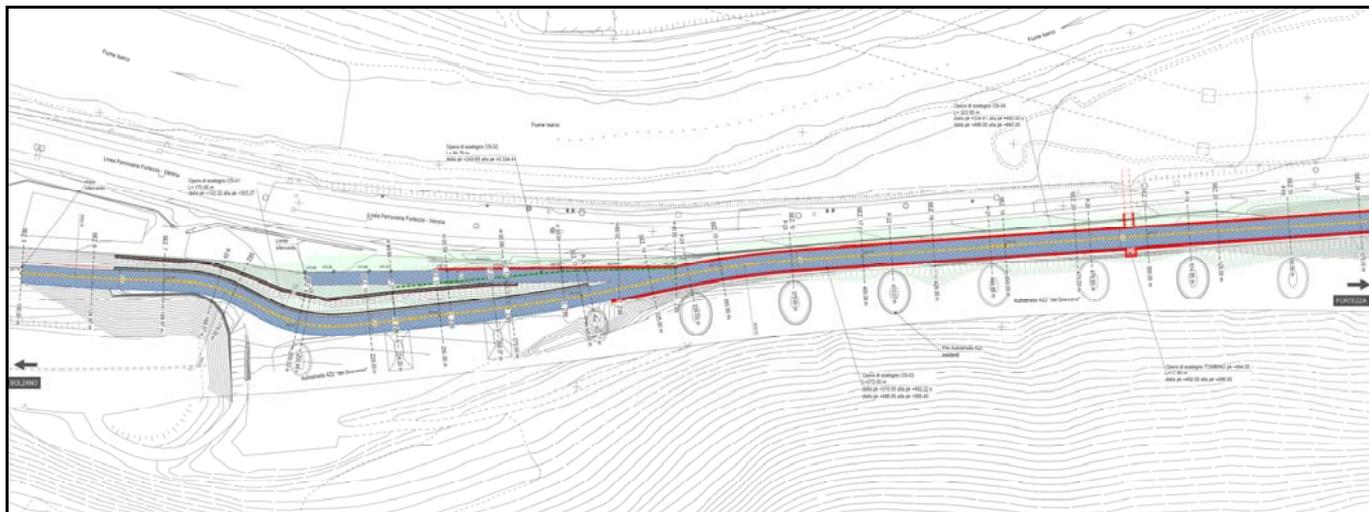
Planimetria di progetto (tra le progressive 0+100.00 m e 0+575.00 m)
